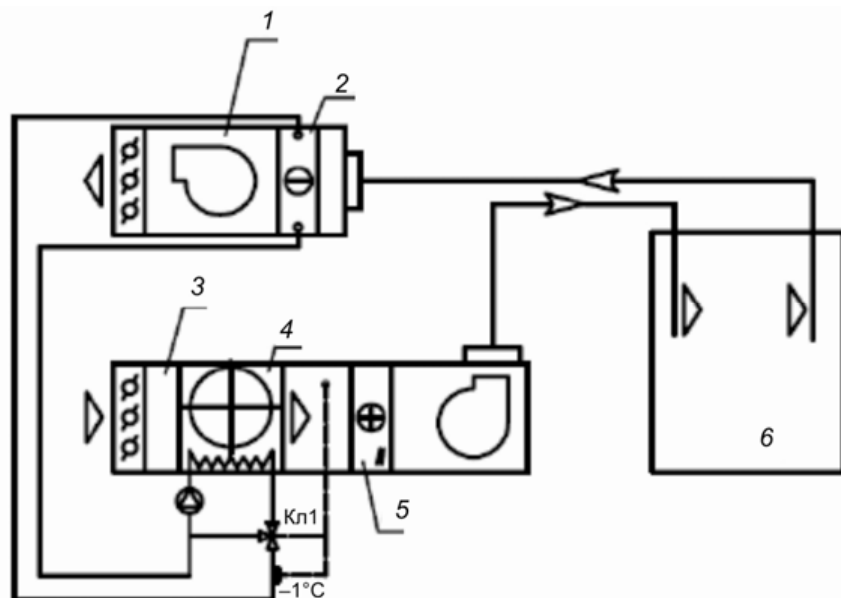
Принципиальная схема СКВ проточного типа (без рециркуляции) с утилизацией теплоты вытяжного воздуха: 1 — вытяжная установка; 2 — поверхностный воздухоохладитель; 3 — приточная установка; 4 — РПУТ; 5 — поверхностный воздушнонагреватель; 6 — обслуживаемые помещения
